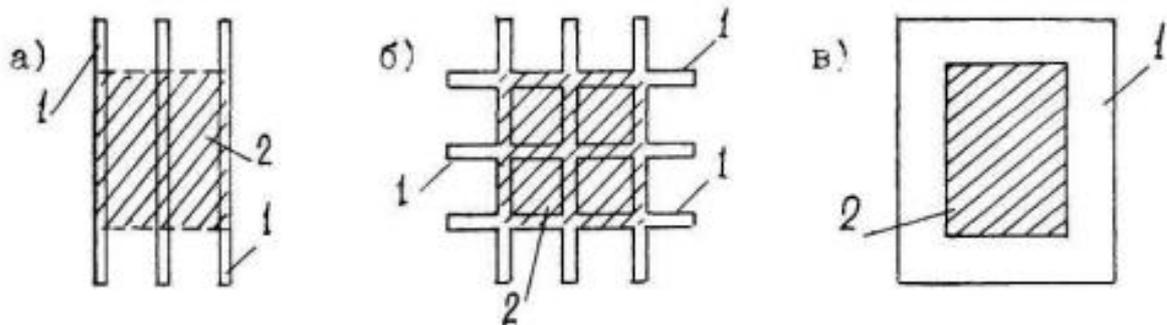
Типи залізобетонних протикарстових фундаментів: а) – стрічки; б) – перехресні стрічки; в) – плита; 1-консольні випуски; 2- контур споруди
